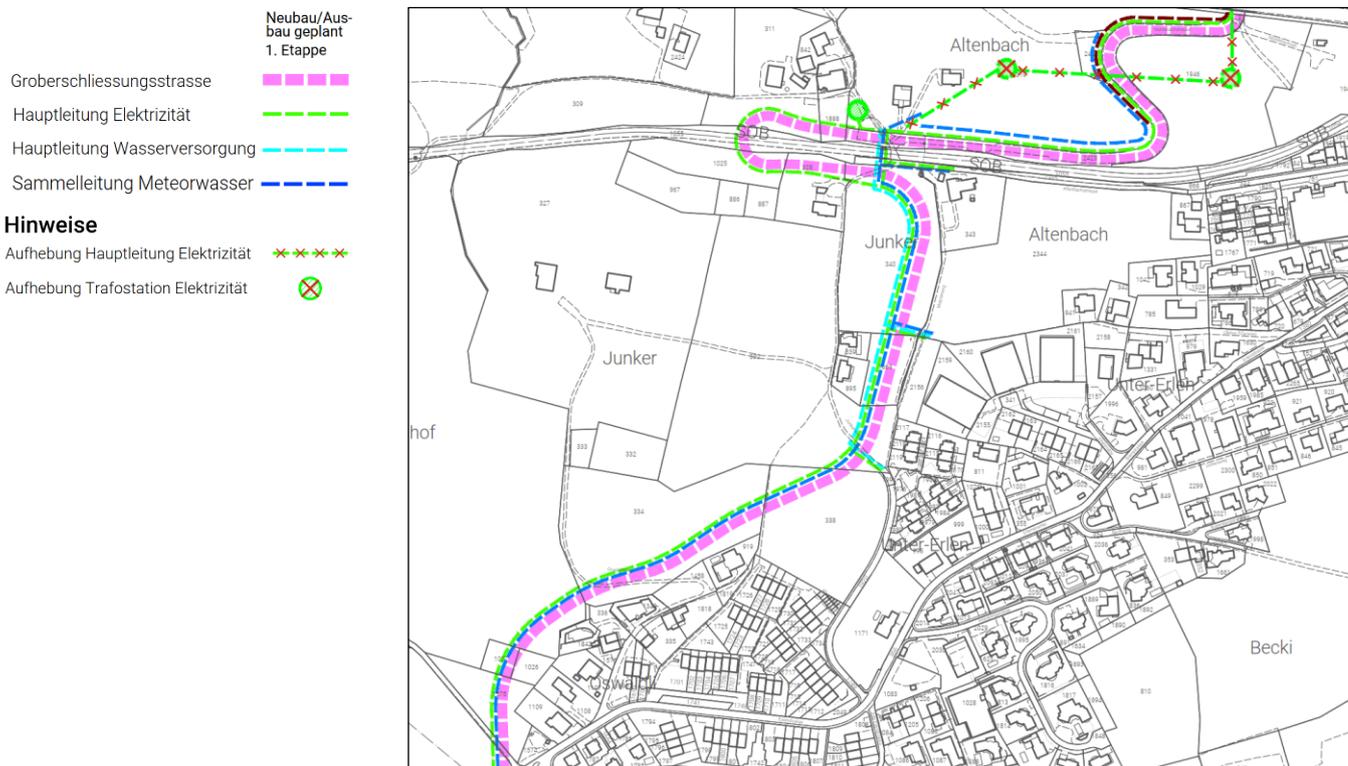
Änderungsplan Erschliessungsplan, Quelle: r+k
